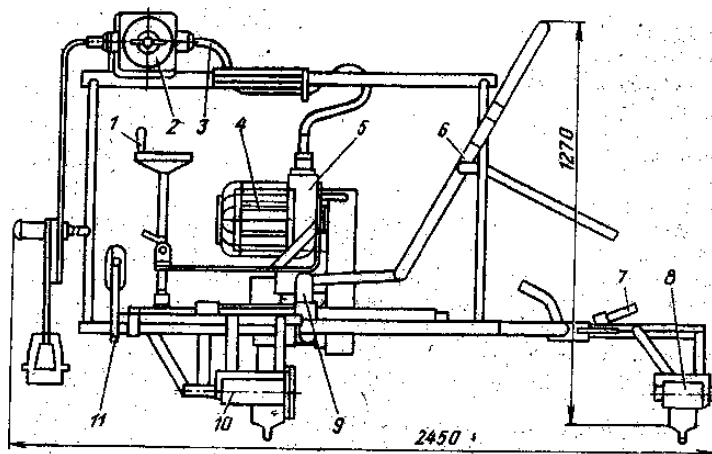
Рельсошлифовальный станок РТ-3:
